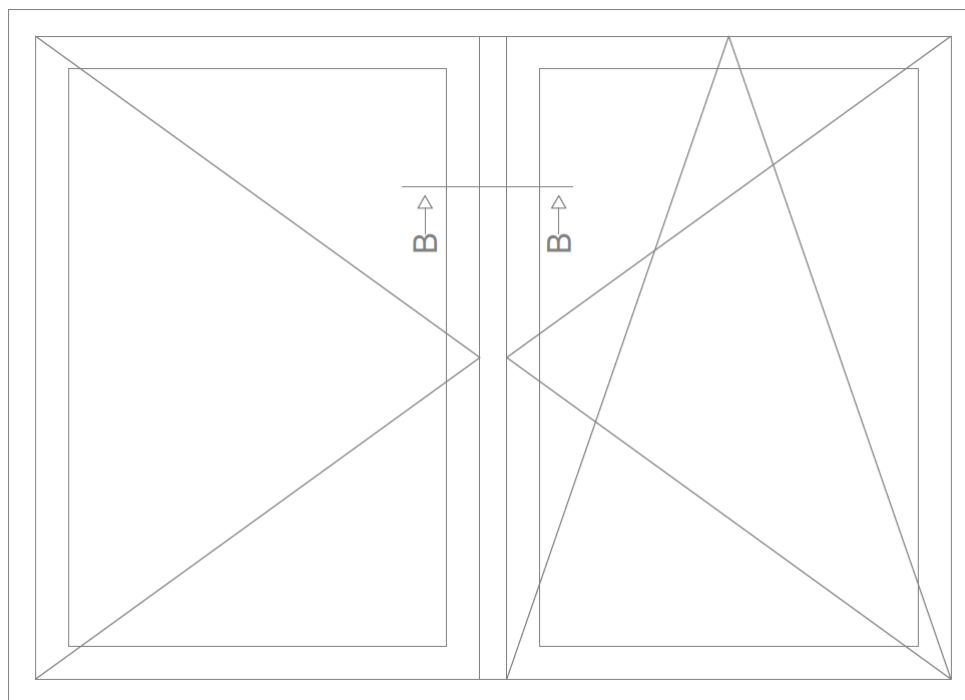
Vista de um caixilho de duas folhas de batente - corte B-B.
